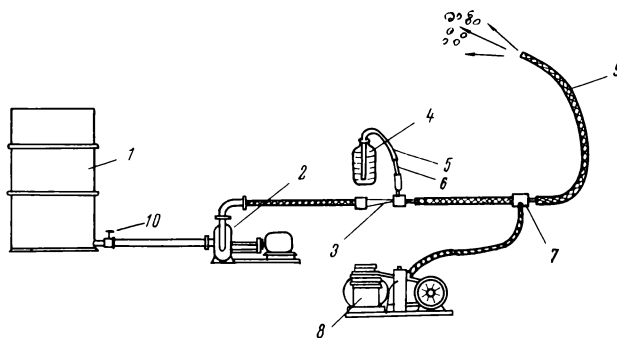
Схема установки для приготовления пены: 1 — тара со смолой (200 л); 2 — насос; 3 — инжектор; 4 — тара для кислоты HCl; 5 — вытяжная трубка; 6 — стеклянная трубка для контроля поступления кислоты; 7 — смеситель; 8 — компрессор; 9 — выводной шланг; 10 — кран
